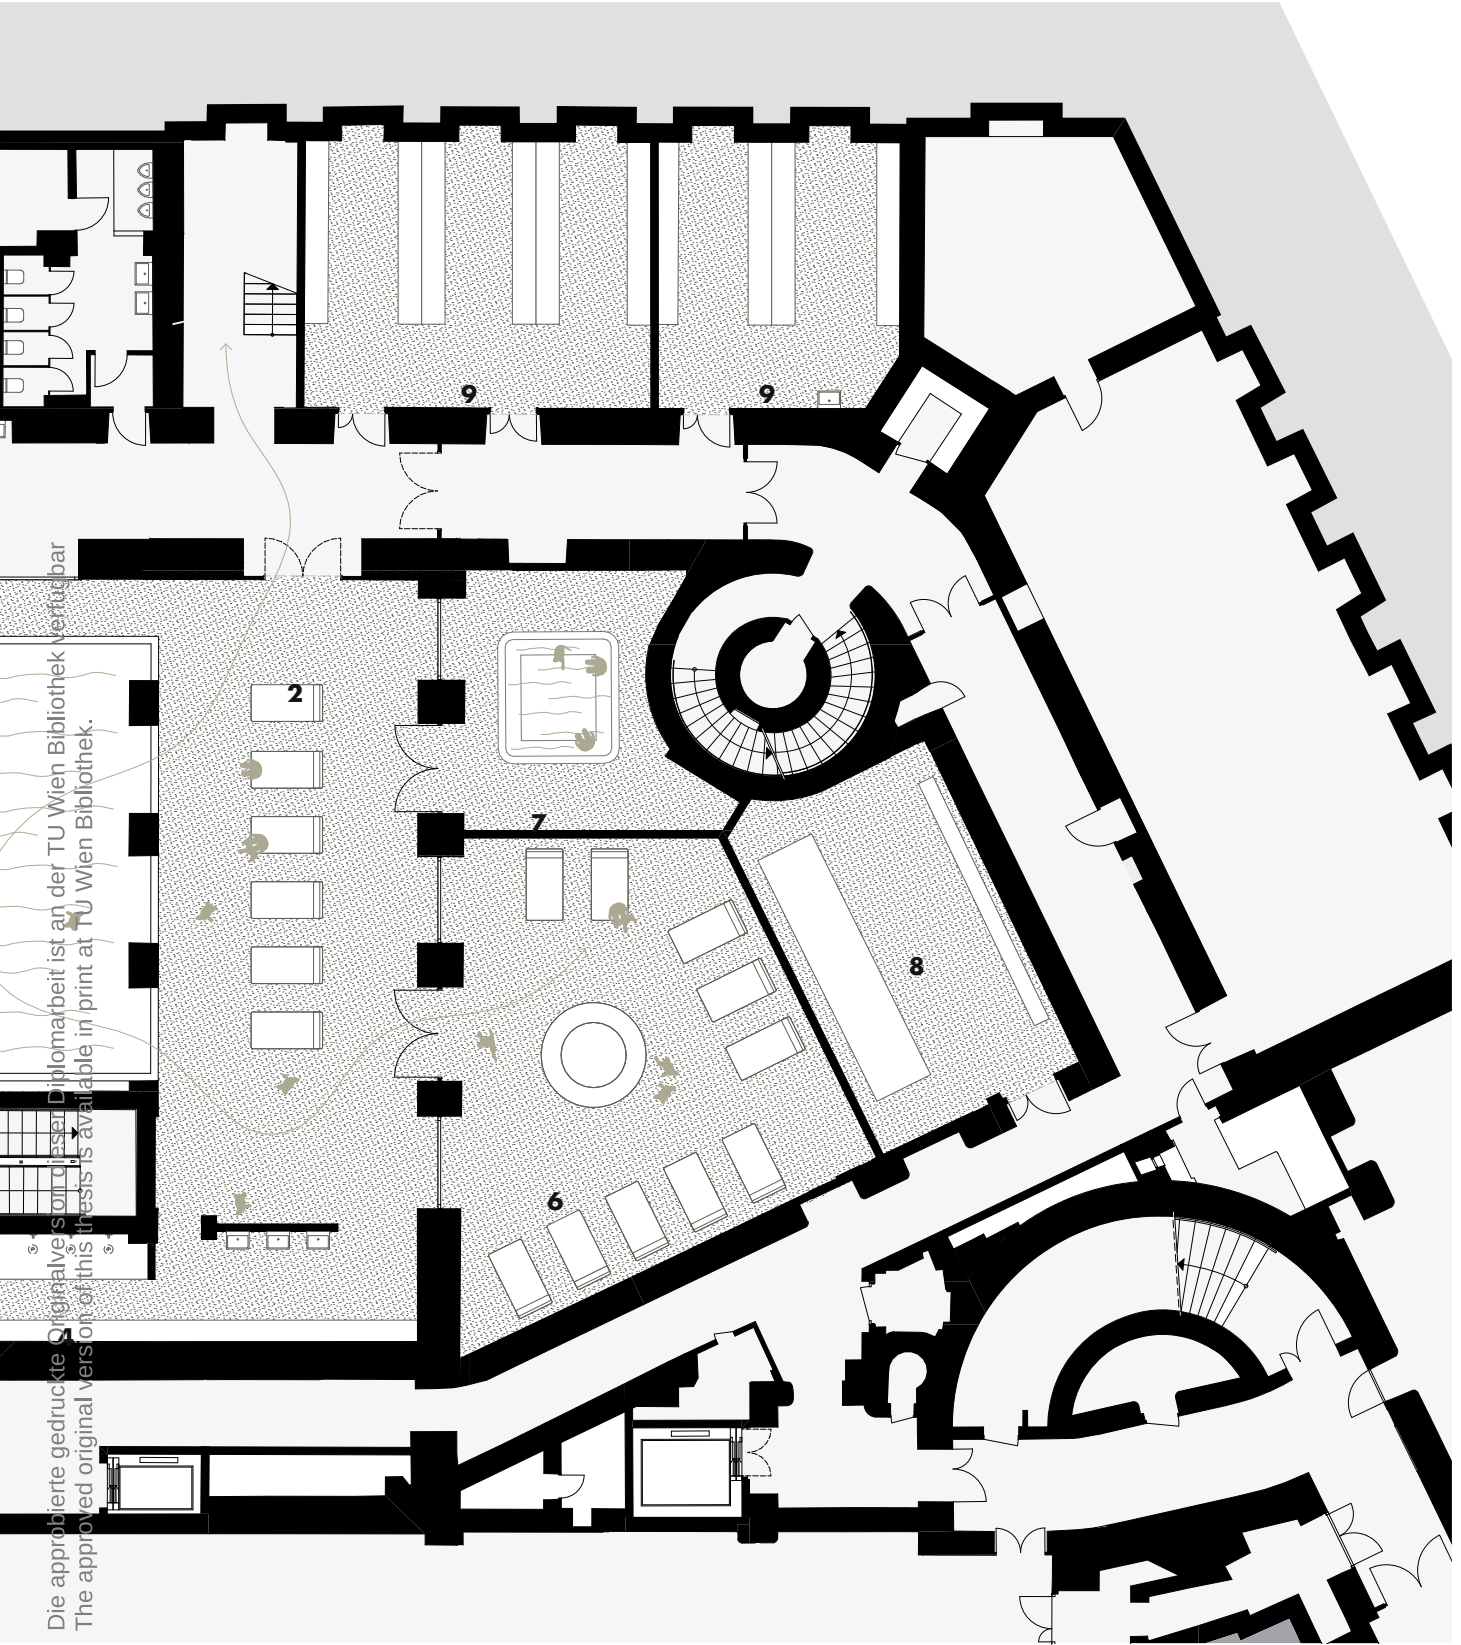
Bauliche Umbaumaßnahmen Grundriss Oberkeller
